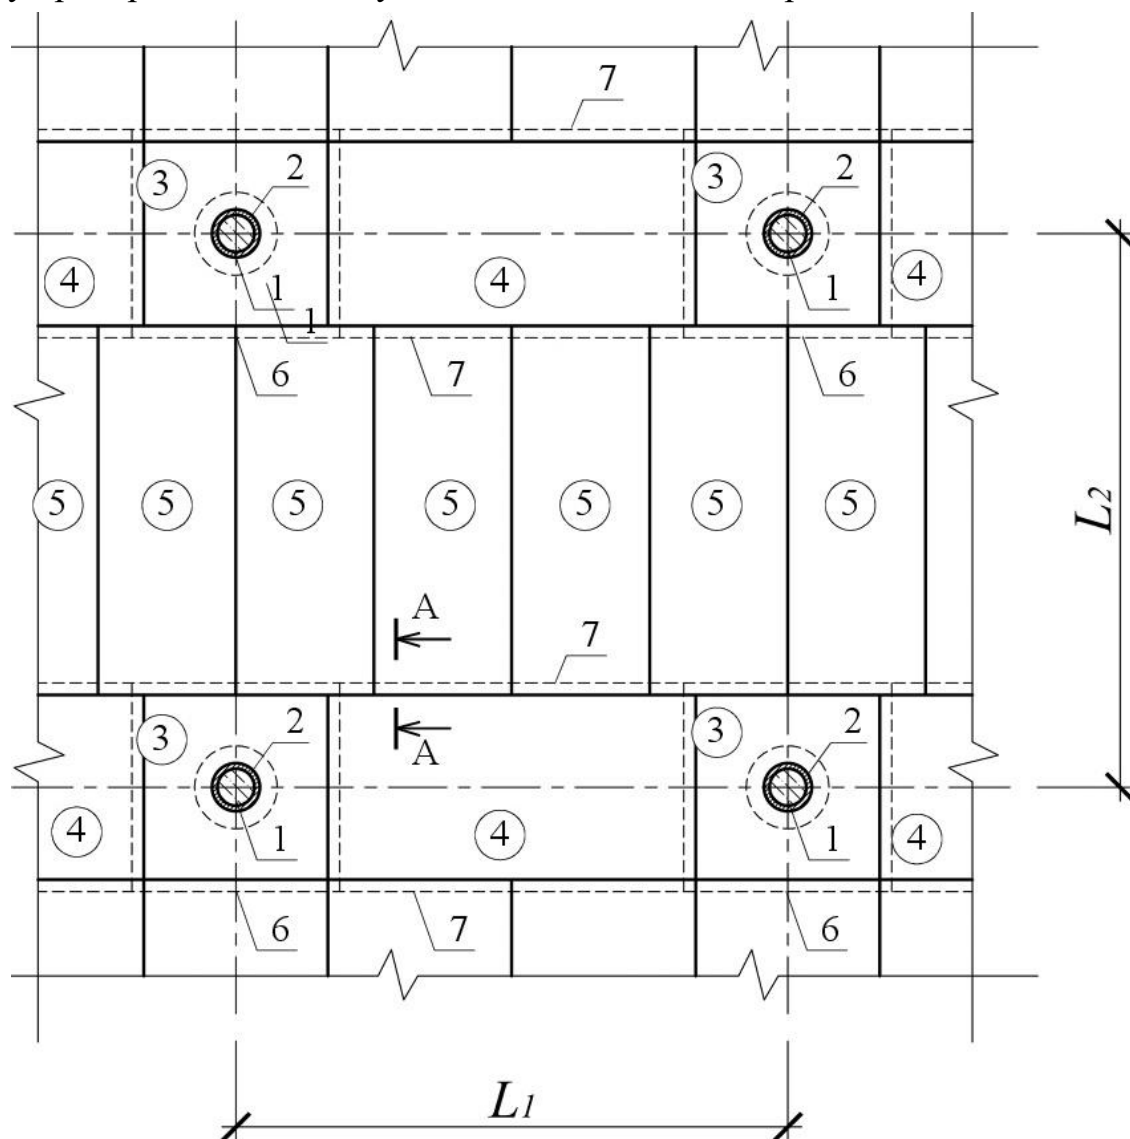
Збірне сталезалізобетонне безбалкове перекриття із пустотними плитами:
